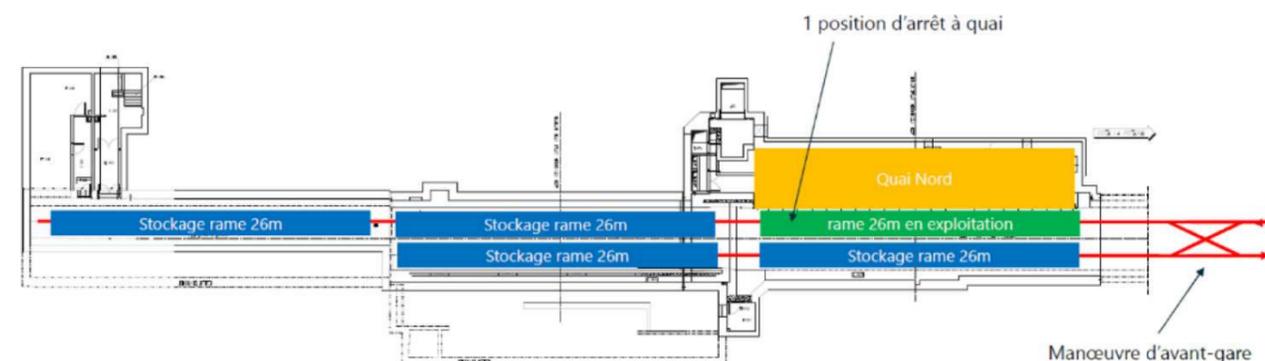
COUPE EN LONG LA STATION EXISTANTE ET DE SON ARRIERE-GARE
